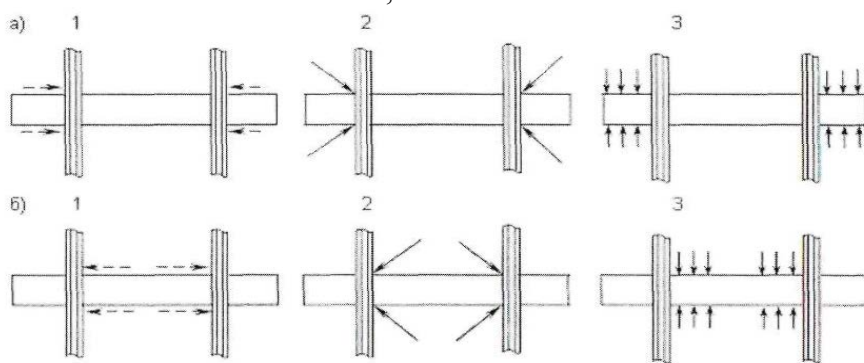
Схемы подбивки шпалы: а-подбивка концов шпалы; б-подбивка внутри колеи
